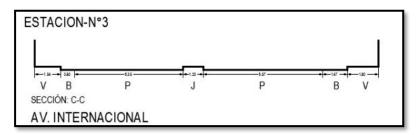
Corte C-C Sección Vial de la Av. Internacional
